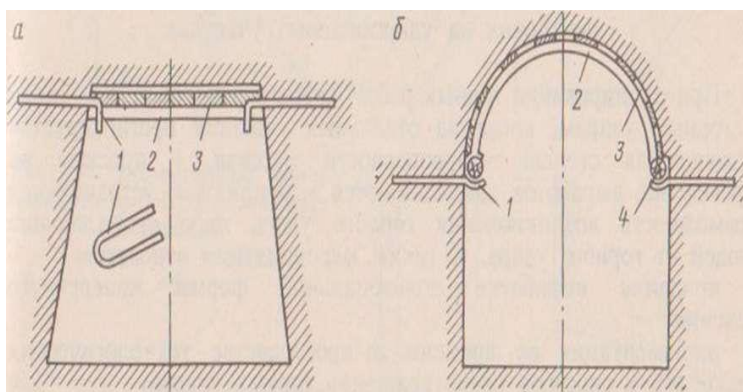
Конструкция металлической бесстоечной крепи: а - с прямолинейным верхняком; б-с криволинейным верхняком; 1 - складной крюк; 2 - верхняк; 3 - затяжка; 4 - деревянный шарнир [2]
